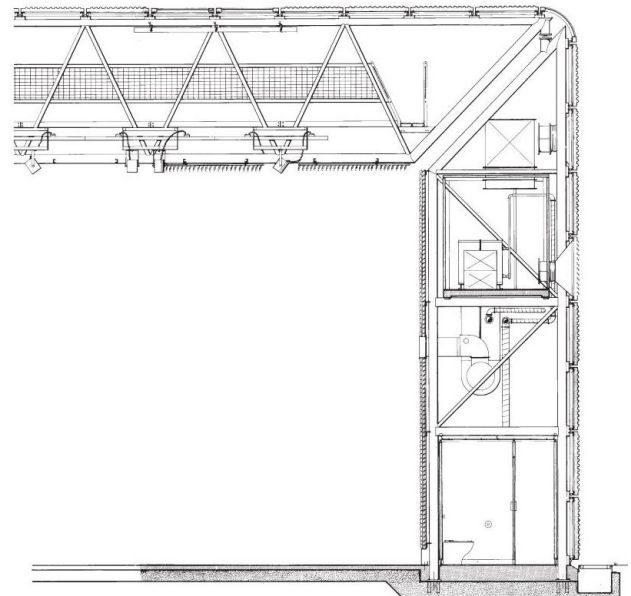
ESQUEMA DONDE SE MUESTRA LA UNIÓN VIGA-PILAR ARTICULADA DE UN PÓRTICO TIPO (2 APOYOS SUPERIORES Y SIN APOYO INFERIOR)
